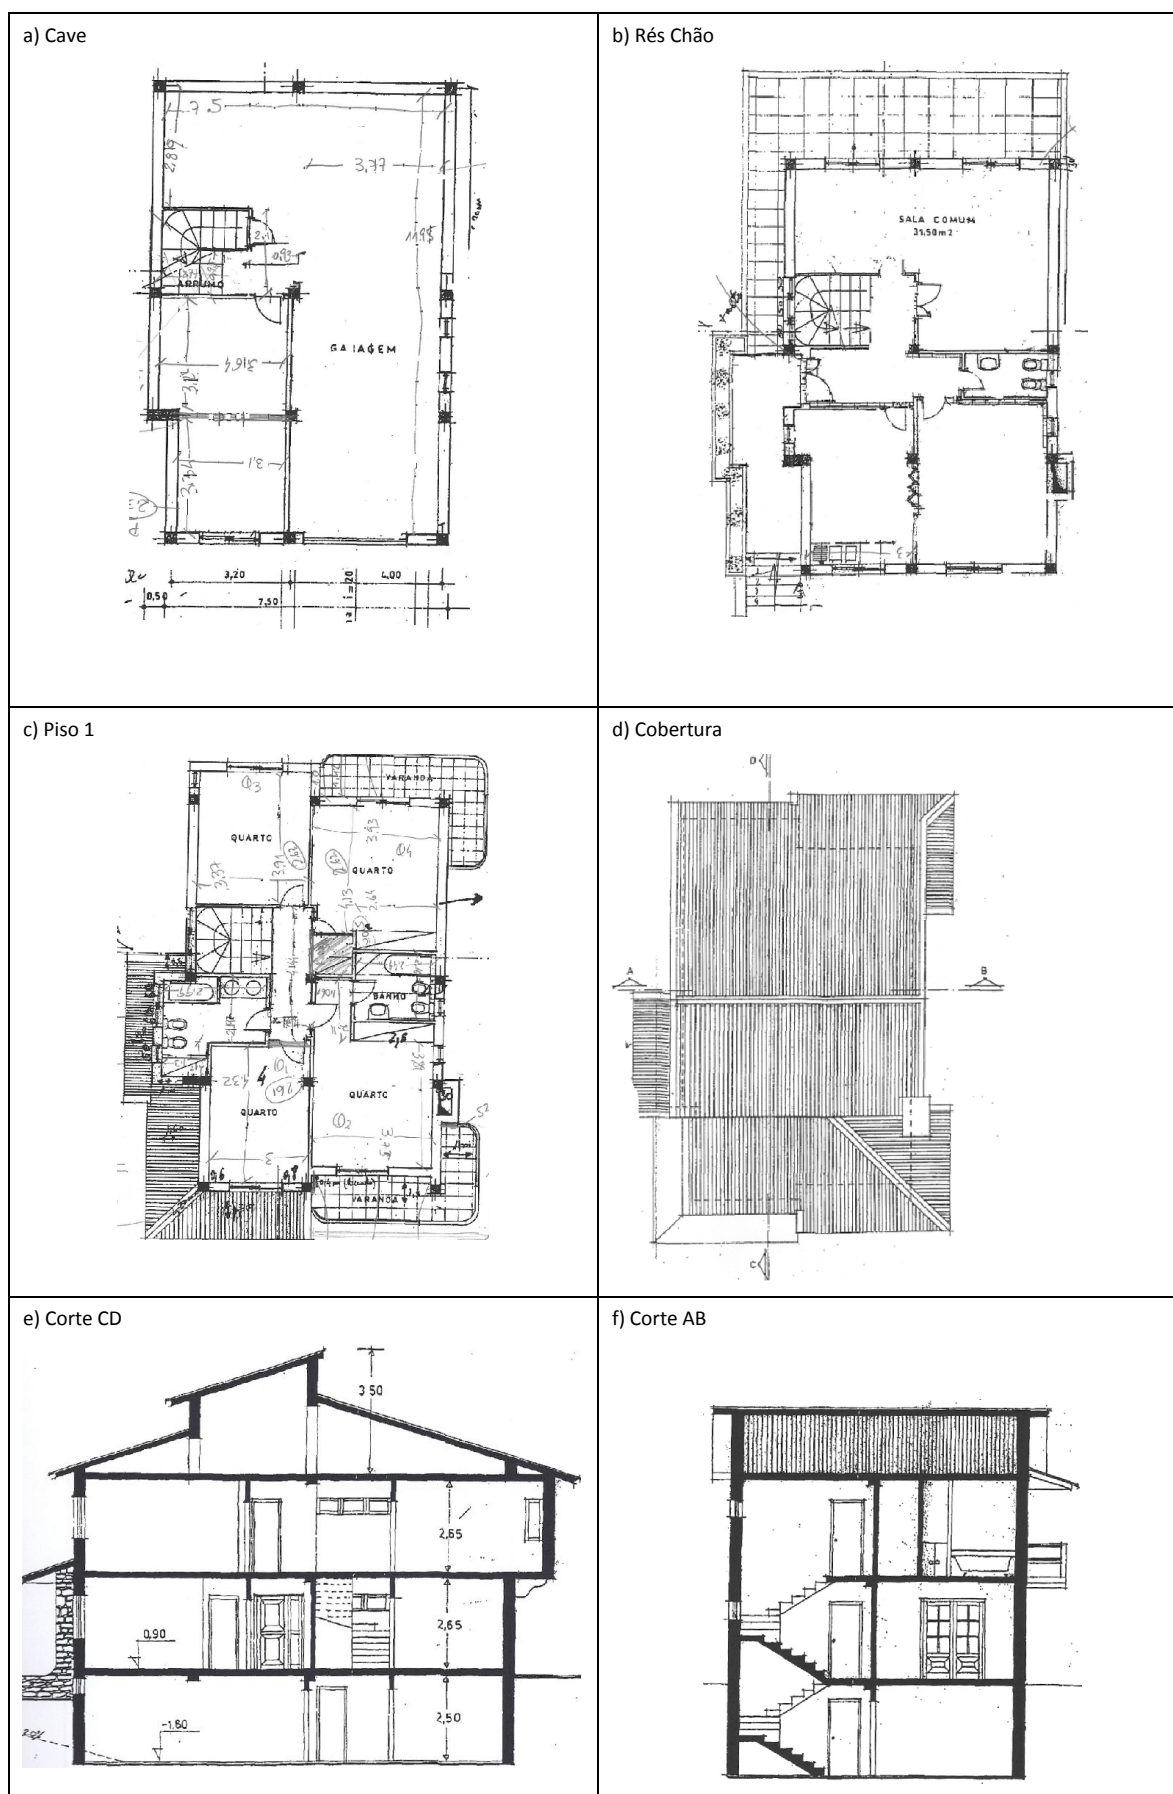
Plantas/cortes de uma moradia construída em 1997
